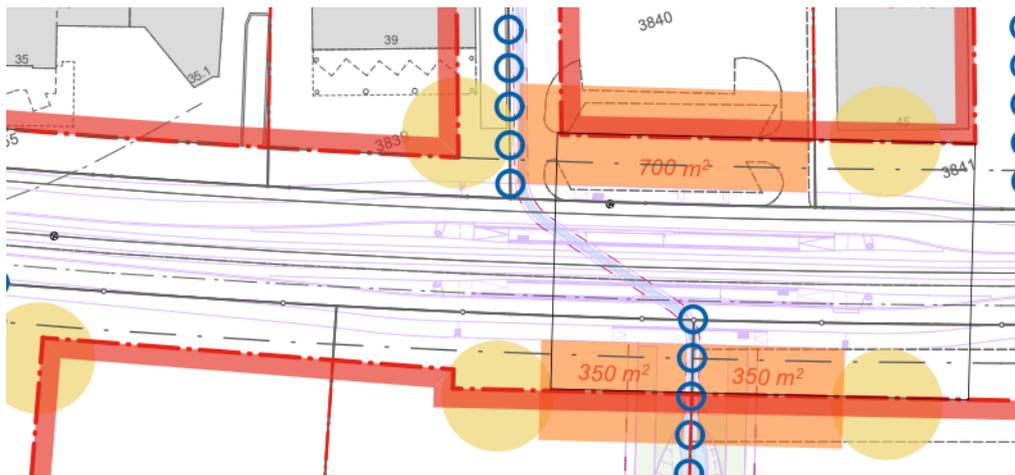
Ausschnitt aus Ergänzungsplan Steinacker mit Glattalbahnprojekt und Verlegung Bedenseebach (Informationsinhalt)
